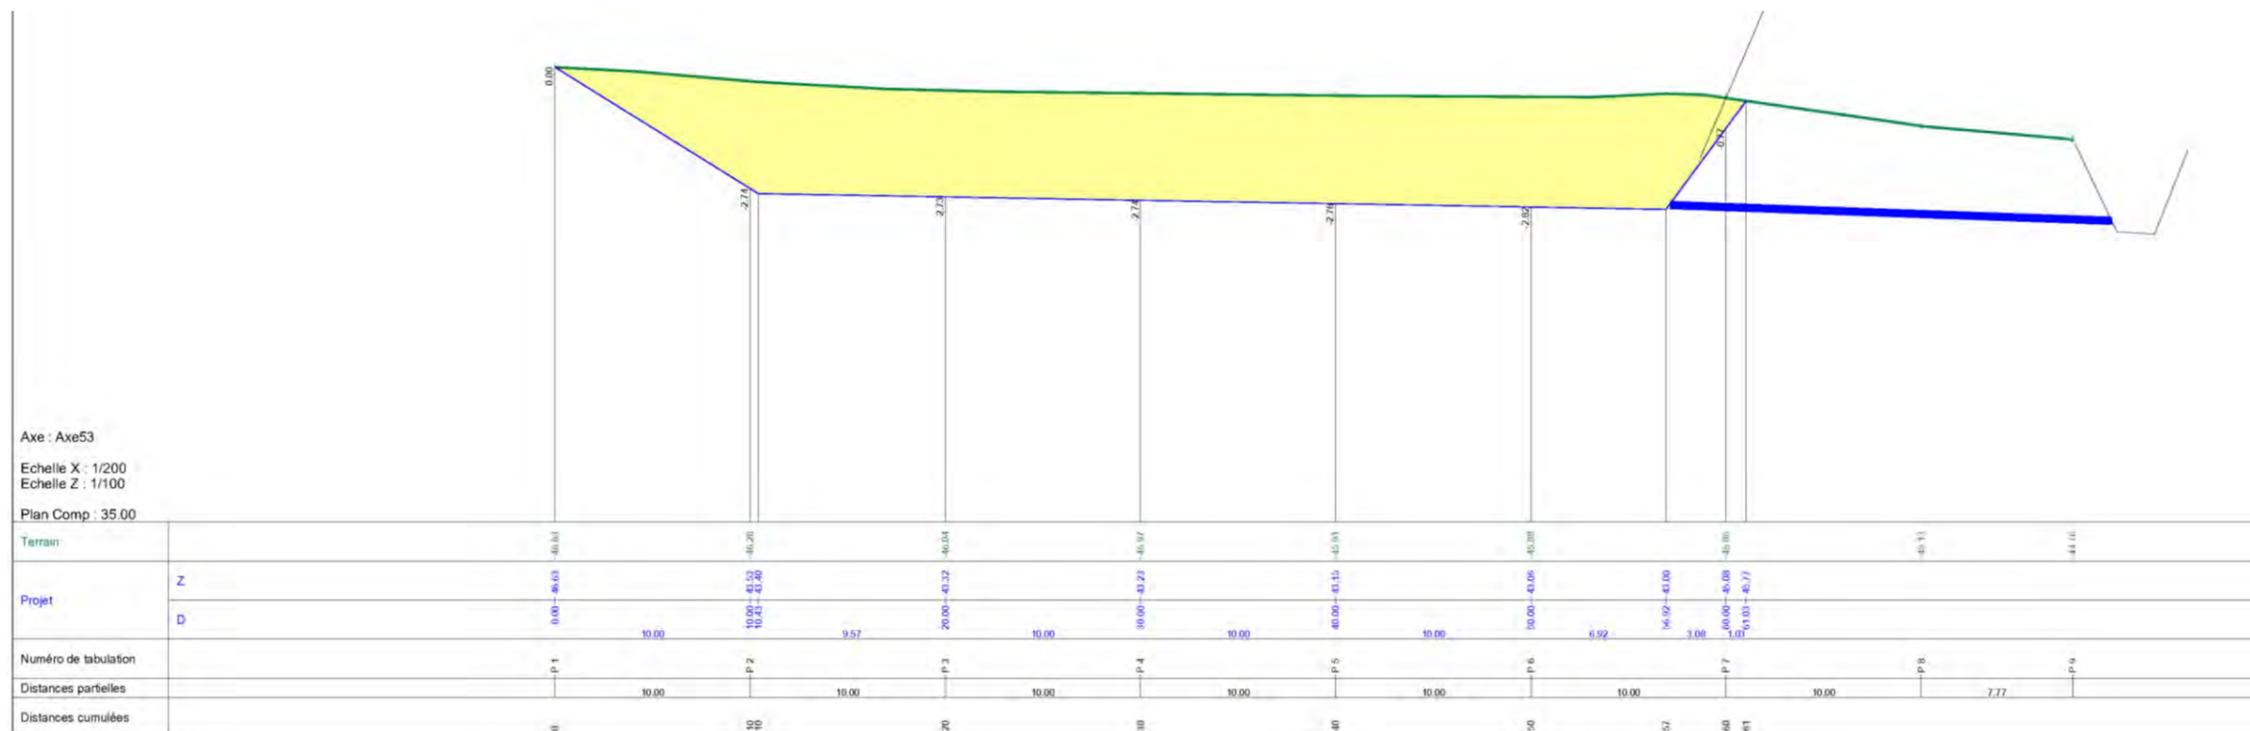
Coupe du bassin de gestion des eaux pluviales B7 (source : TdM)
